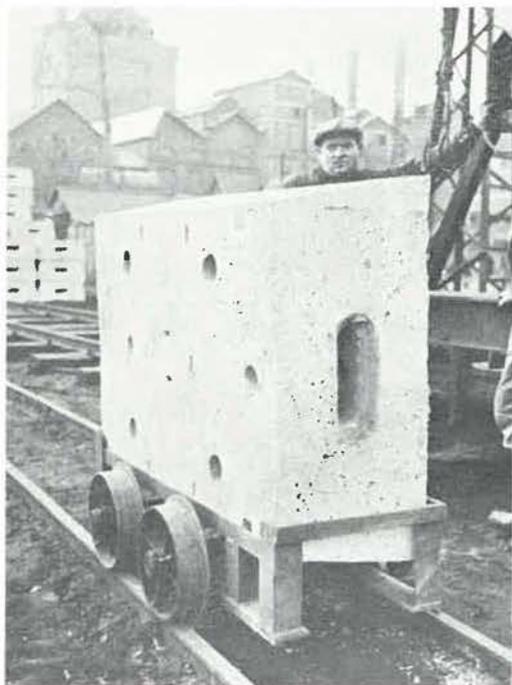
Claveau de béton placé sur un truck pour sa descente dans l'avaleresse.
